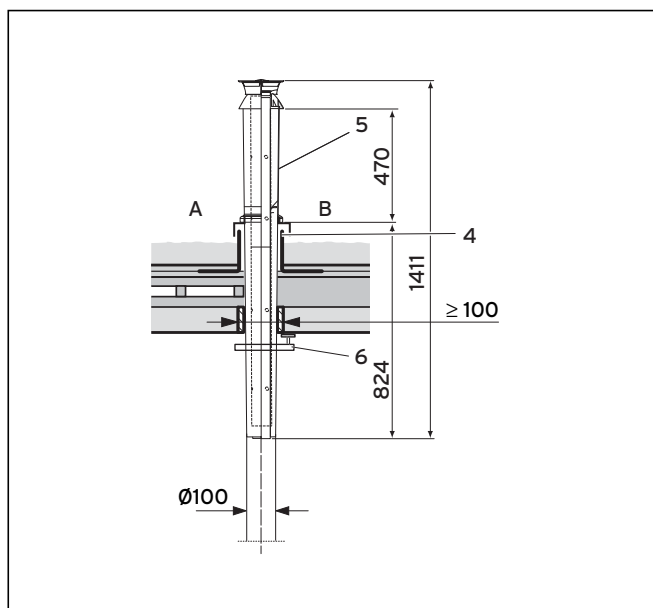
Montaggio passante a tetto attraverso tetti piani
